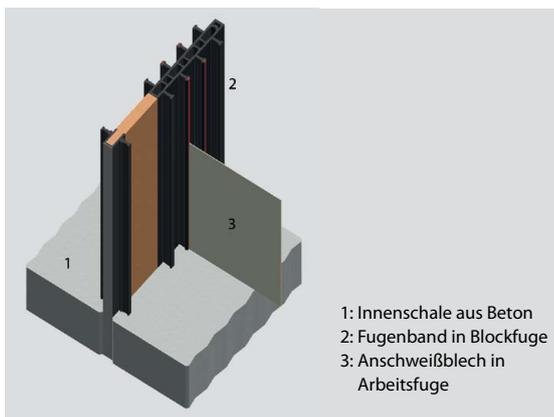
Fugenband in Blockfuge mit anvulkanisierten Anschweißblechen für Arbeitsfuge
